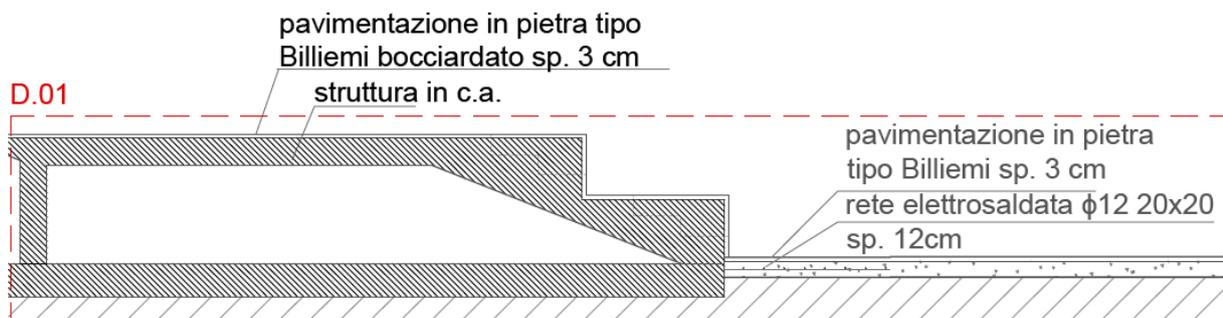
Dettaglio in sezione della ripavimentazione della banchina
